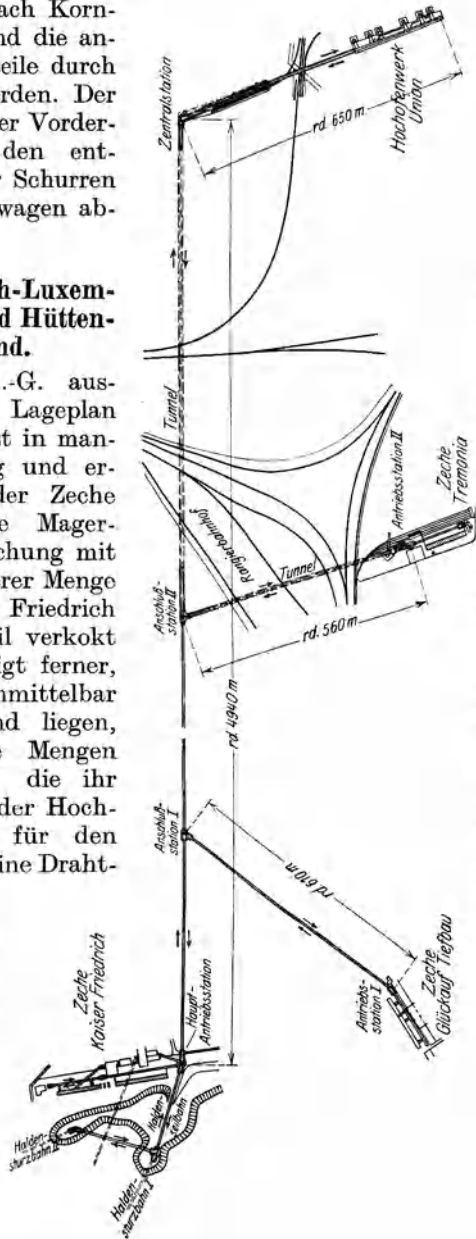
Lageplan der Tunnelbahnen bei Dortmund (Pohlig).
